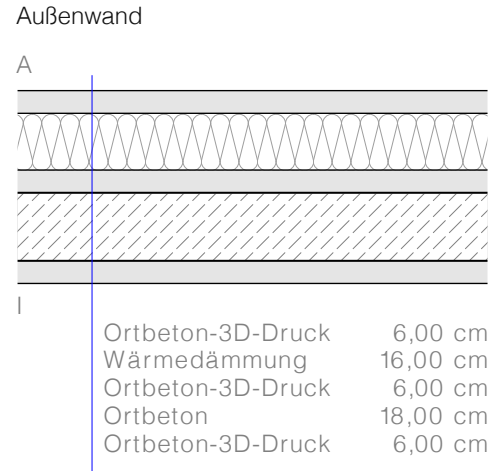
EFH Wandaufbau Außenwand | M 1.20
